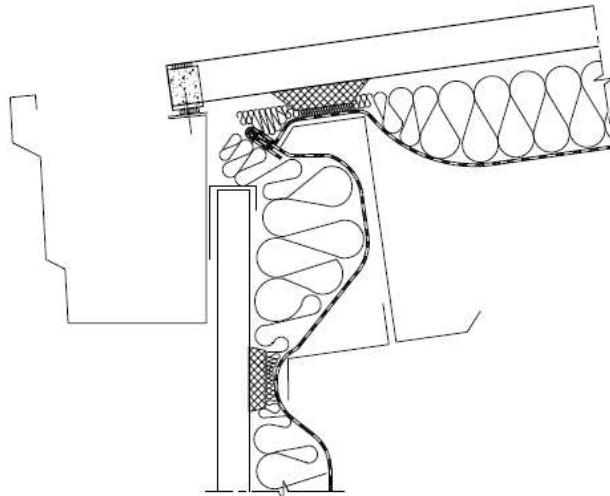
3: Beispiel für einen Traufanschluss, Wand aus Trapezblech, Industriedach mit Stahltrapezprofilen, als einschalige Konstruktion
